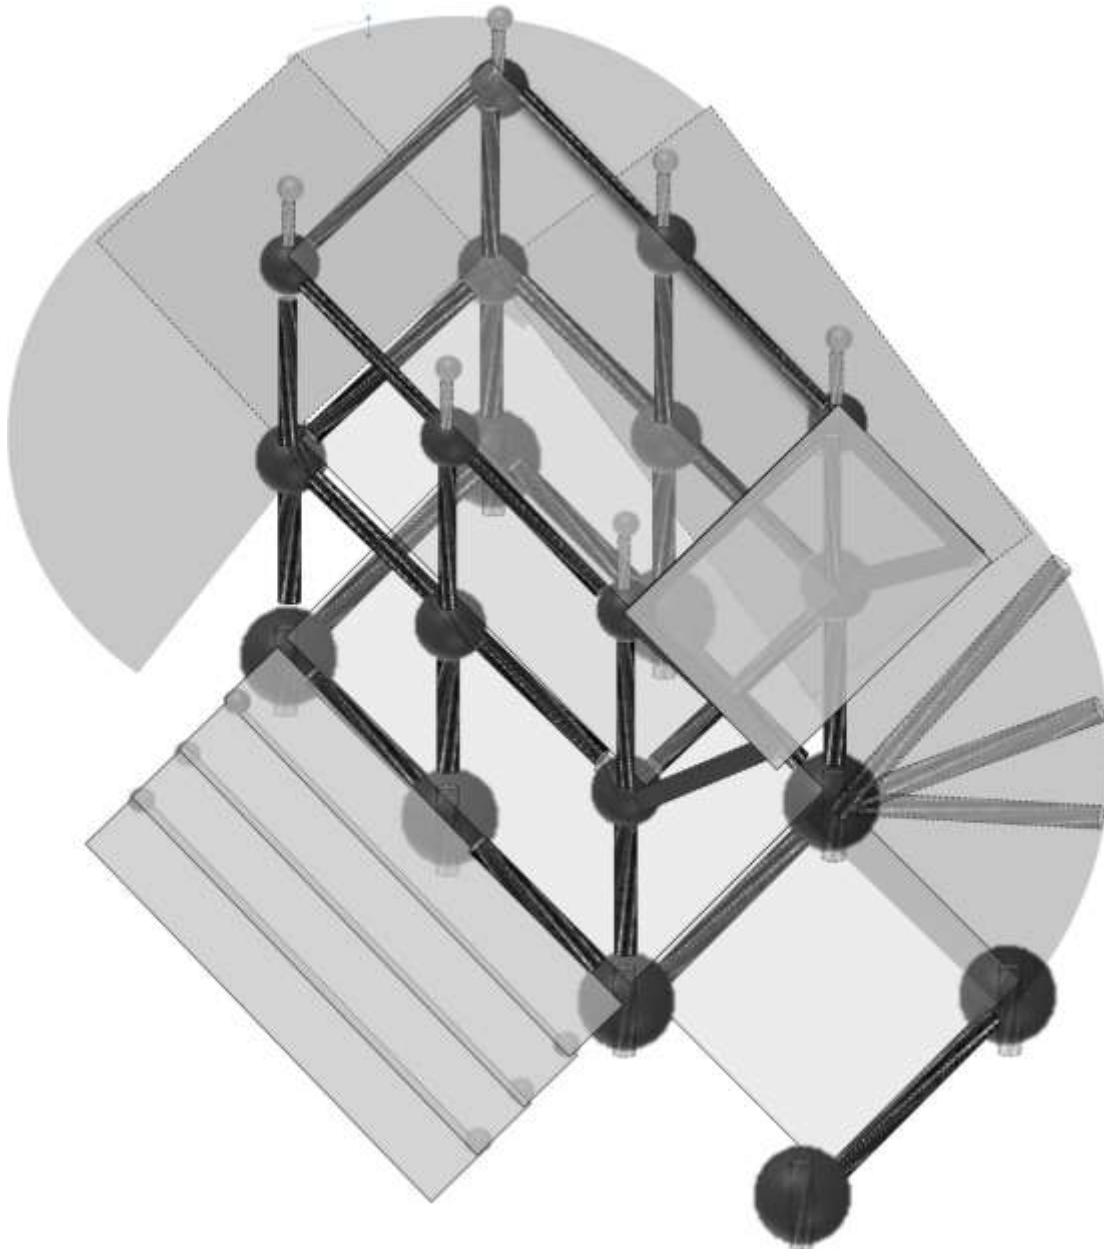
'Ensamblado de la estructura'. Elaboración propia
